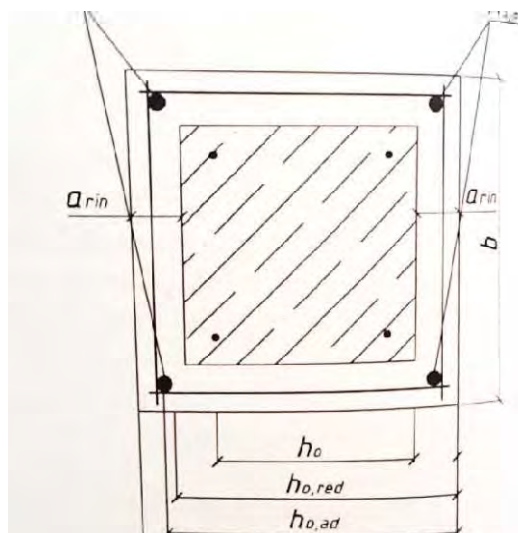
К расчету усиления колонн железобетонной обоймой
